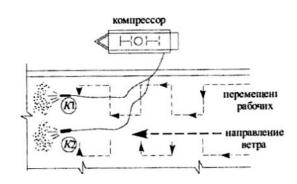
Схема организации рабочего места рабочих-кровельщиков: K1 — кровельщик 3-го разряда; K2 — кровельщик 4-го разряда
